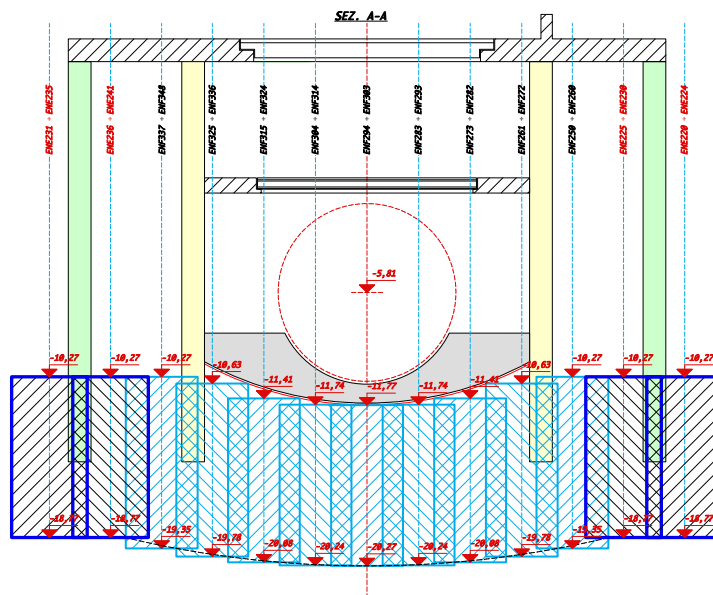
Sezione tipo A dei trattamenti ad Eixample Nord.
